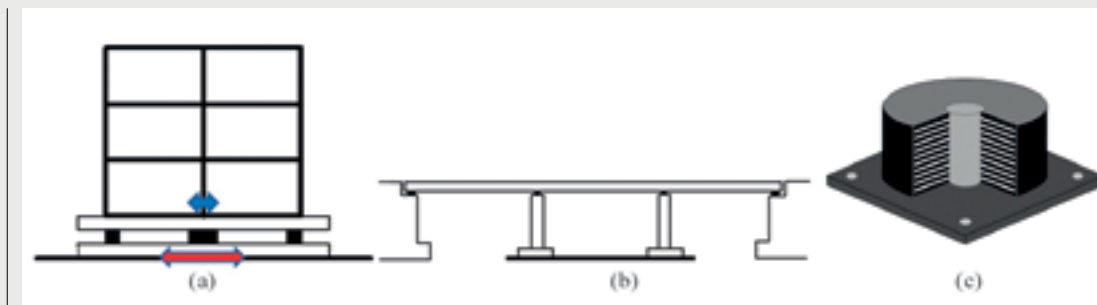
Sistema di isolamento in (a) edifici e (b) ponti. (c) Esempio di Isolatore sismico di tipo elastomerico ad elevato smorzamento (HDRB).
